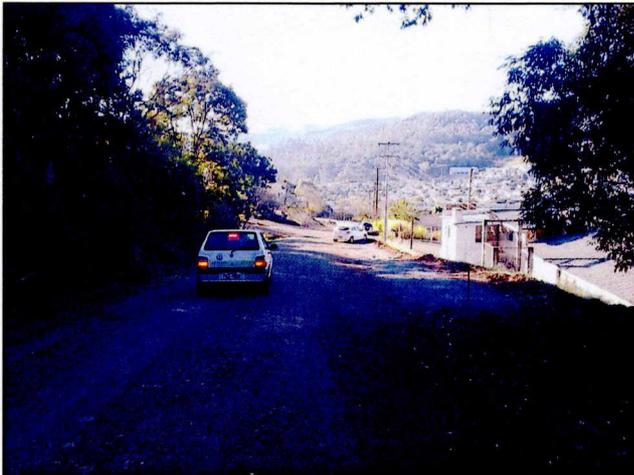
vista norte do leito da Rua existente a ser regularizada, conforme ponto 01 do projeto;
